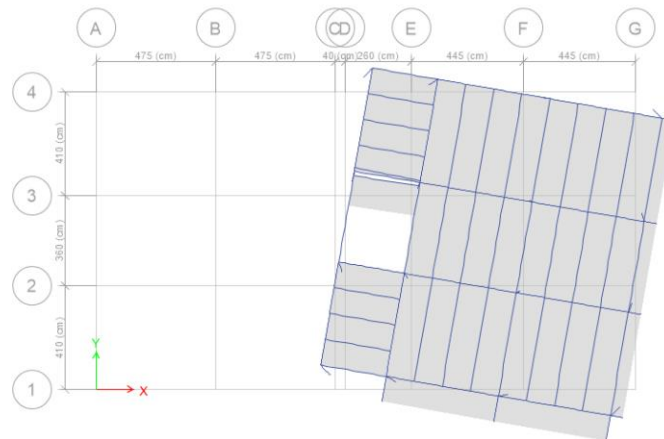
Zona B-Vista en planta tercer modo de vibración. Rotación en z (ETABS).
